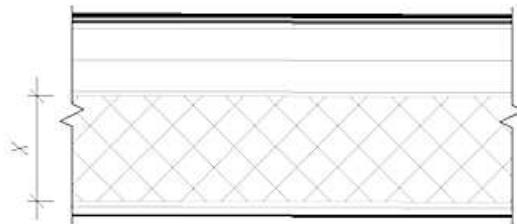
Расчетная схема мансардного перекрытия
